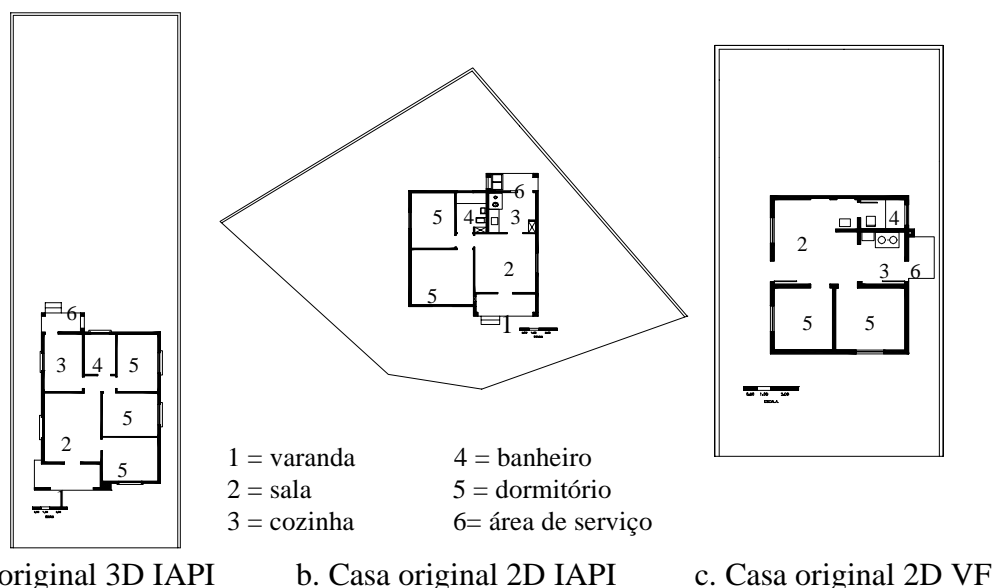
Plantas das casas originais no IAPI e na Vila Farrapos
